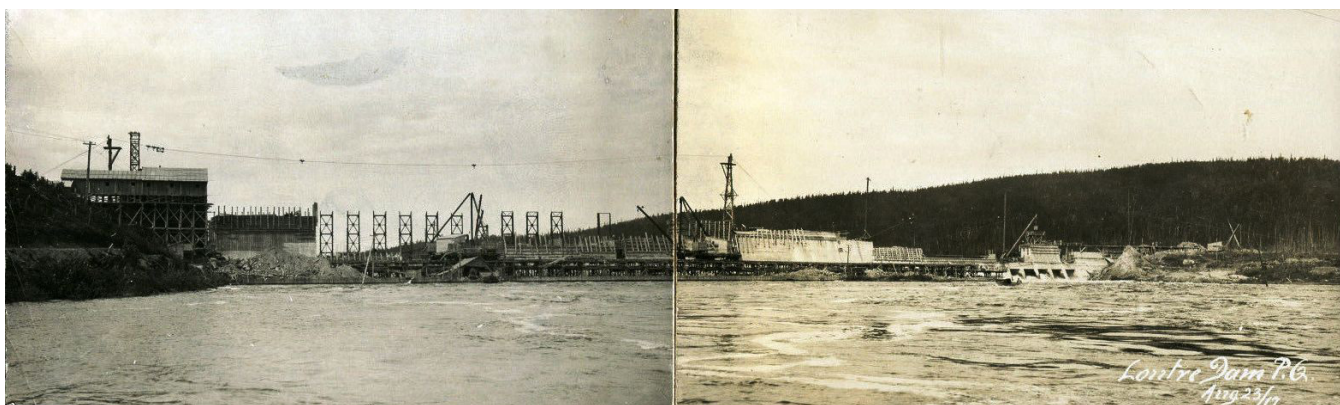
Le barrage la Loutre lors de la construction, le 23 août 1917 [Source : eBay]
